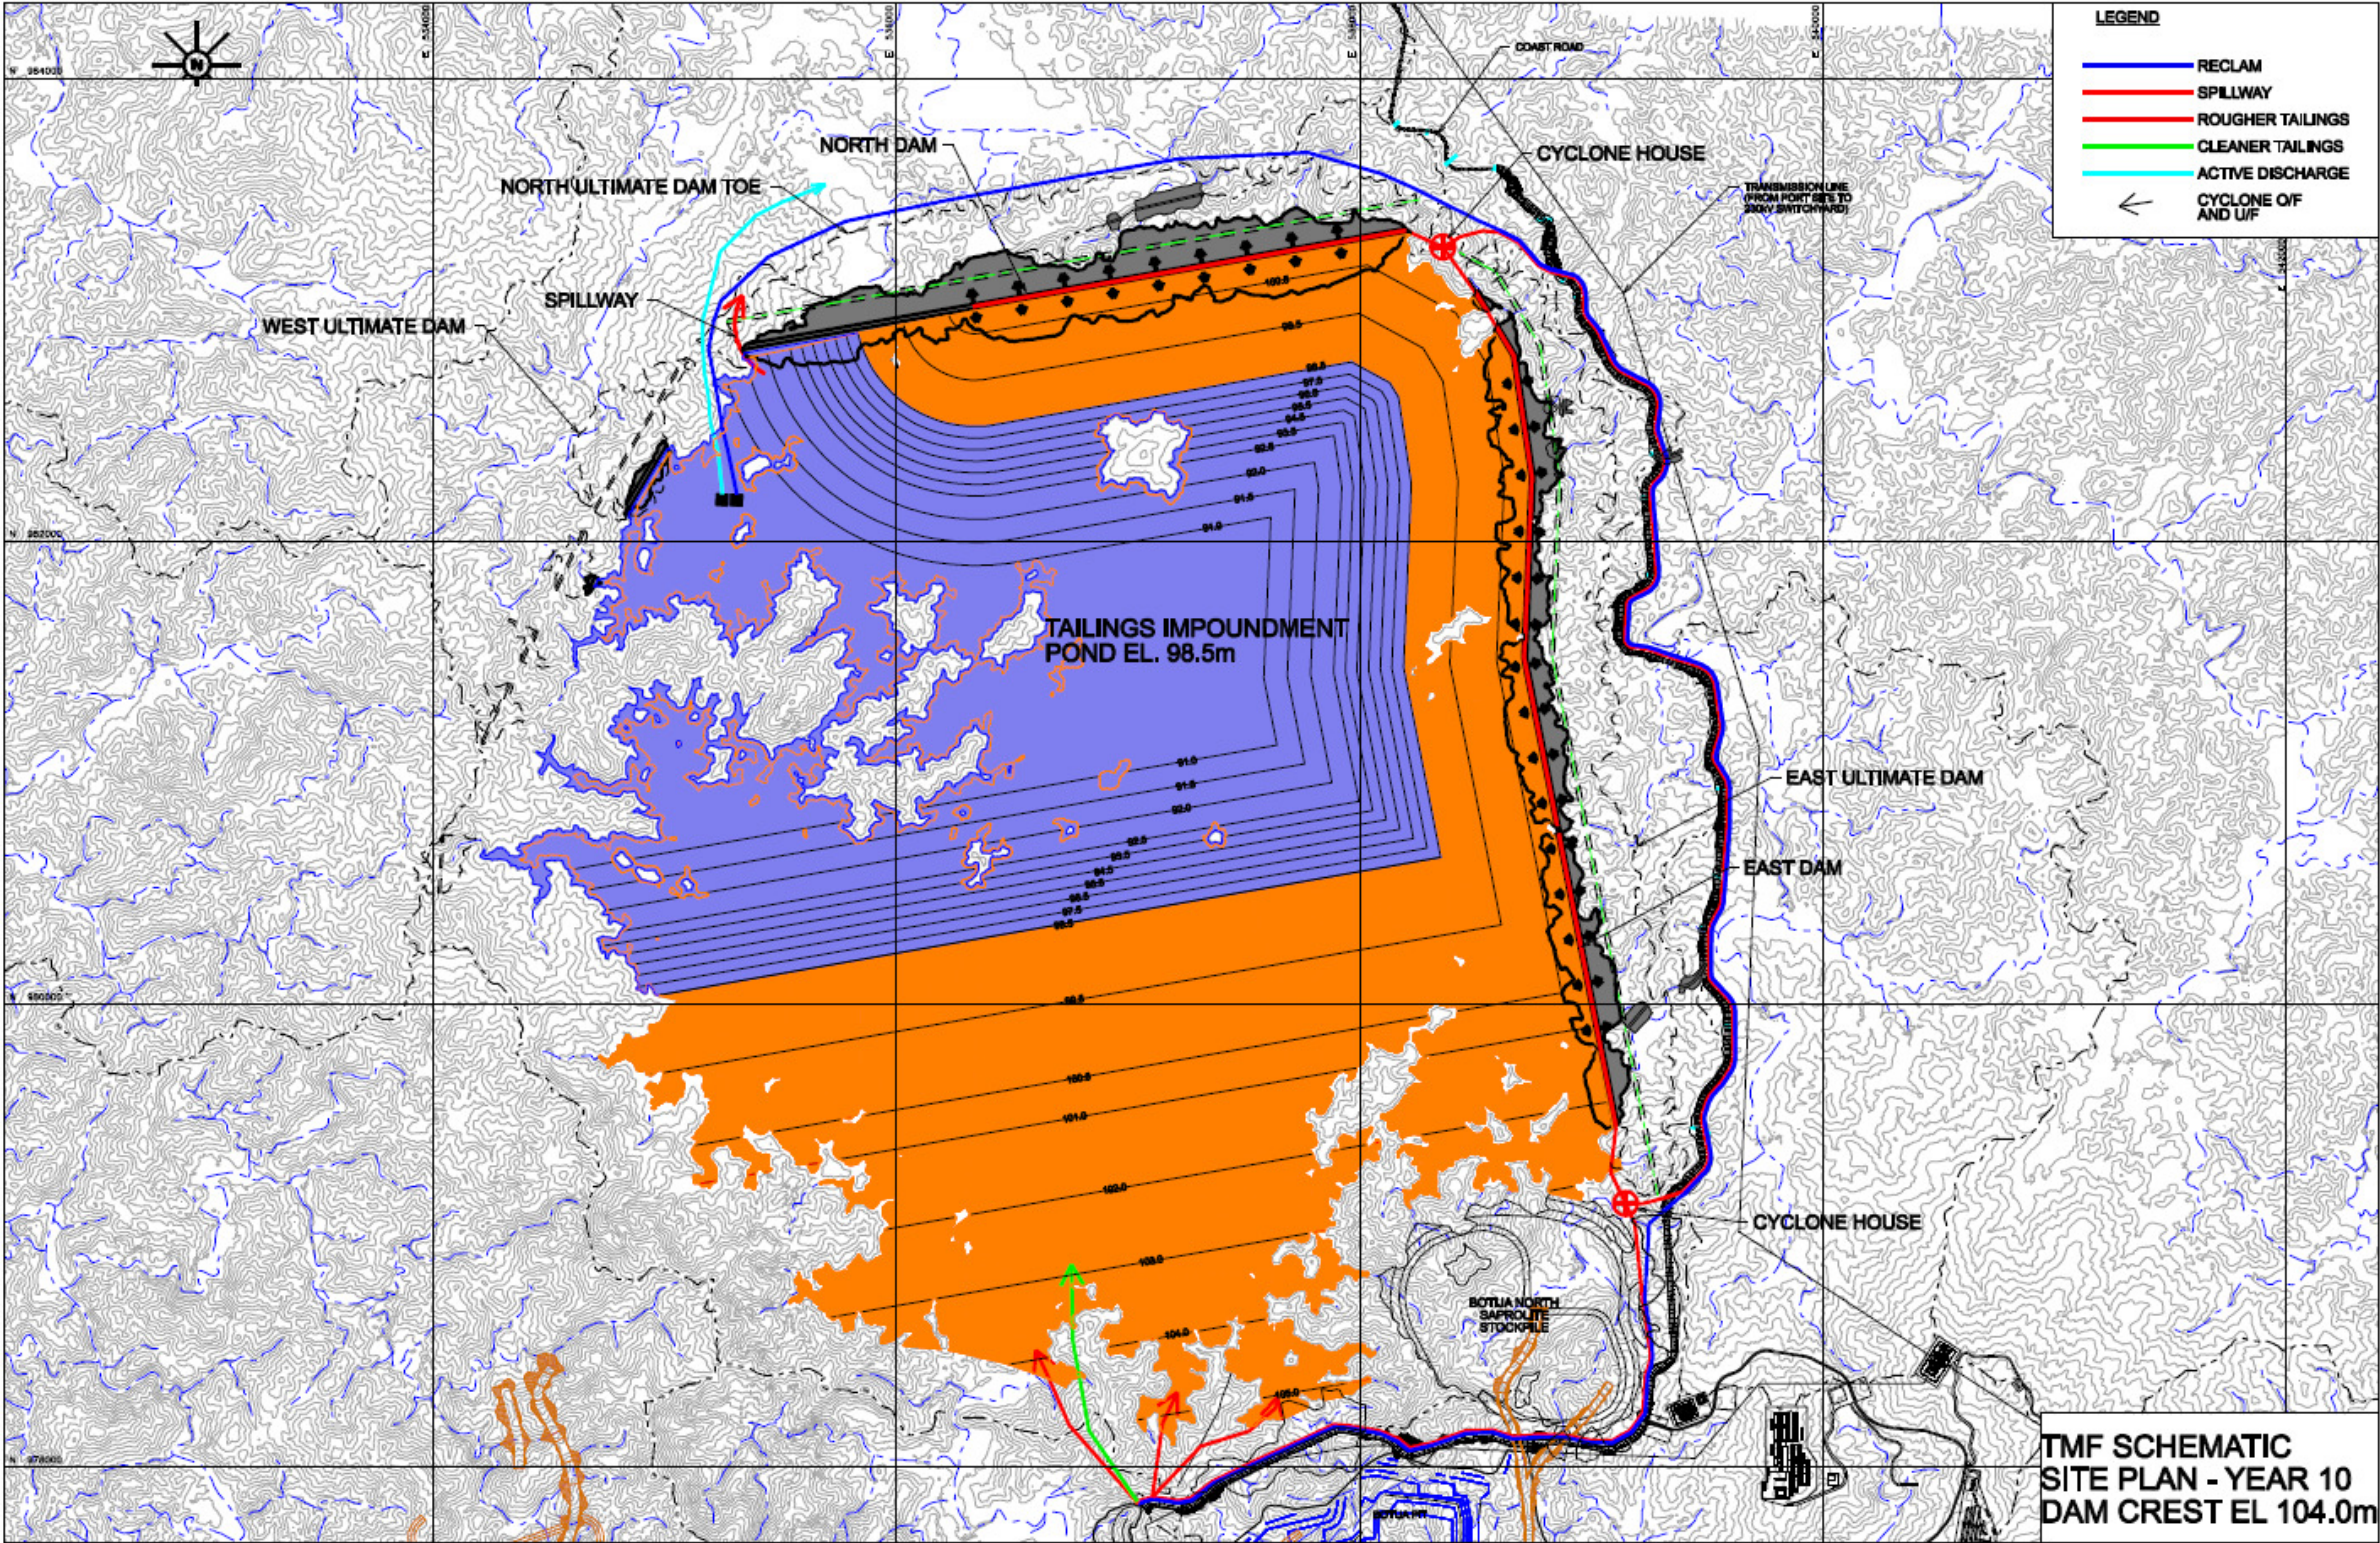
4: Tailings Management Facility Site Plan at Year 10
